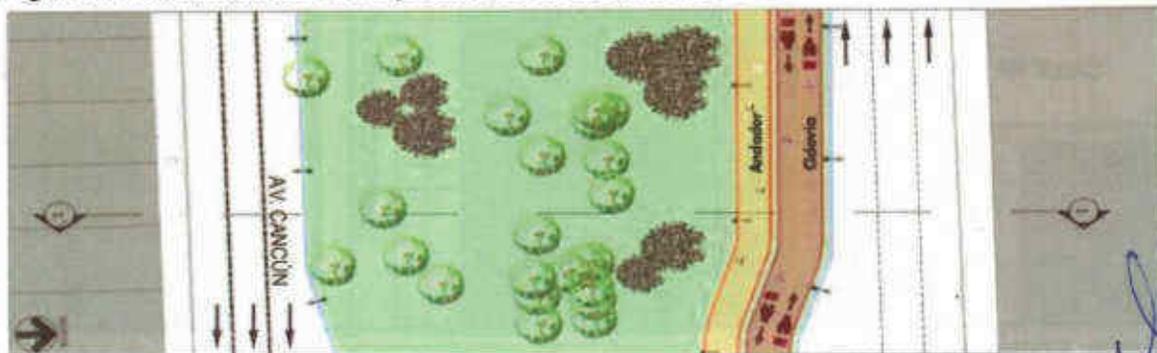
Situación con Proyecto: Corte de planta de la 2b Av. Chac Mool.
